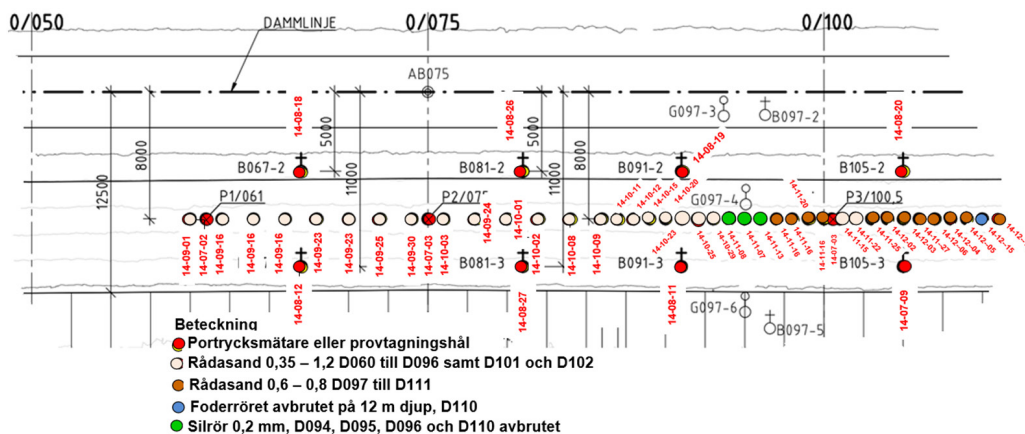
4 Förslag till borrade dräner med visst centrumavstånd med målet att verka i stort sätt som ett kontinuerligt vertikalt nedströmsfilter.
